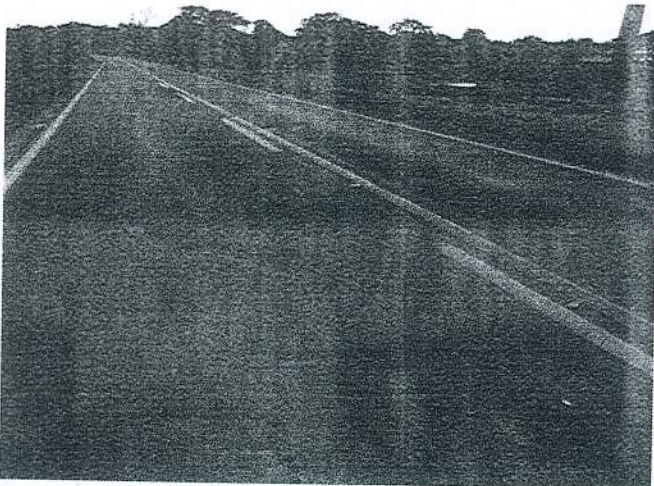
fissuras e afundamento próximos ao eixo.
